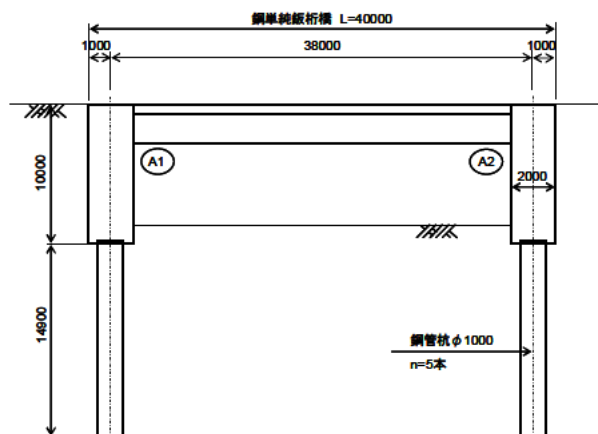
モデル橋梁の概要図 (単位 mm)
